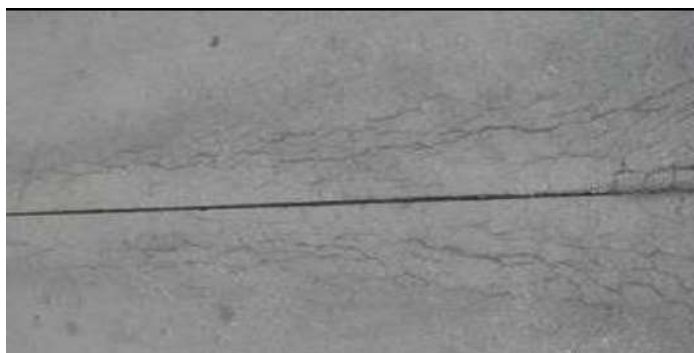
Grieta De Durabilidad “D” de gravedad baja.
